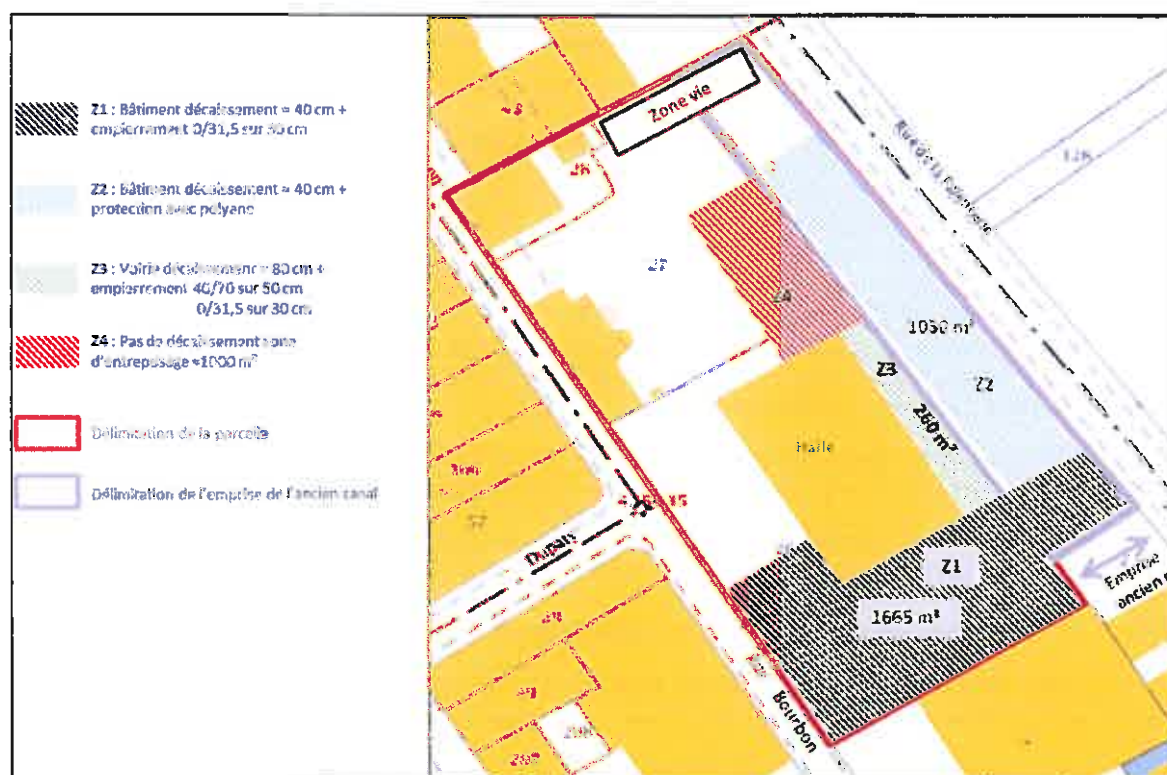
Plan des excavations réalisées début 2015, avant le déclenchement du portique à Lapouyade
